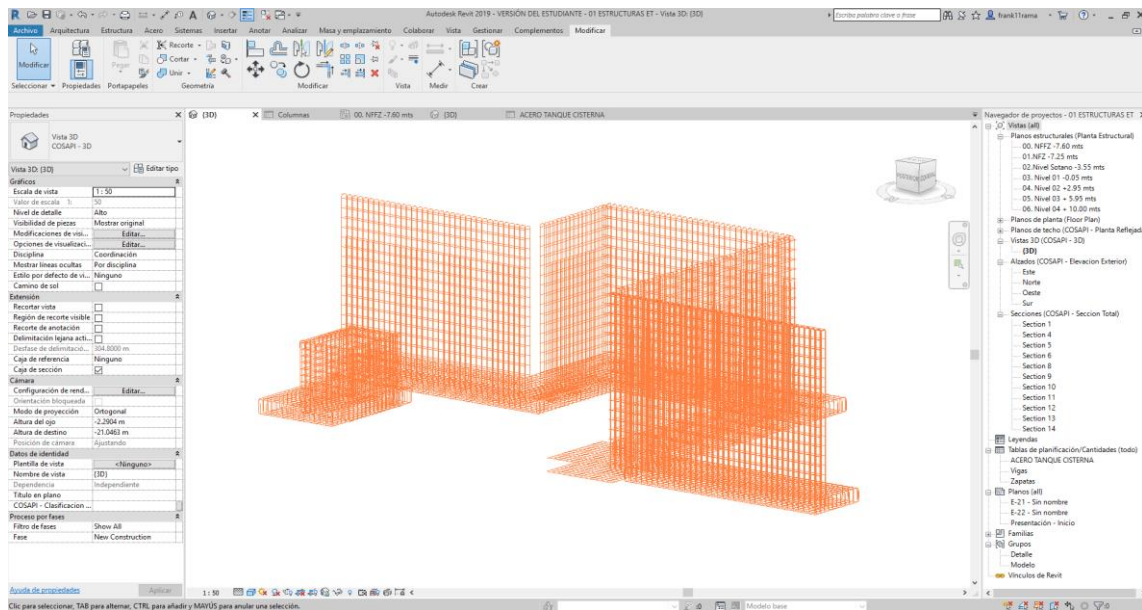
Cuantificación de acero para armadura de tanque cisterna
